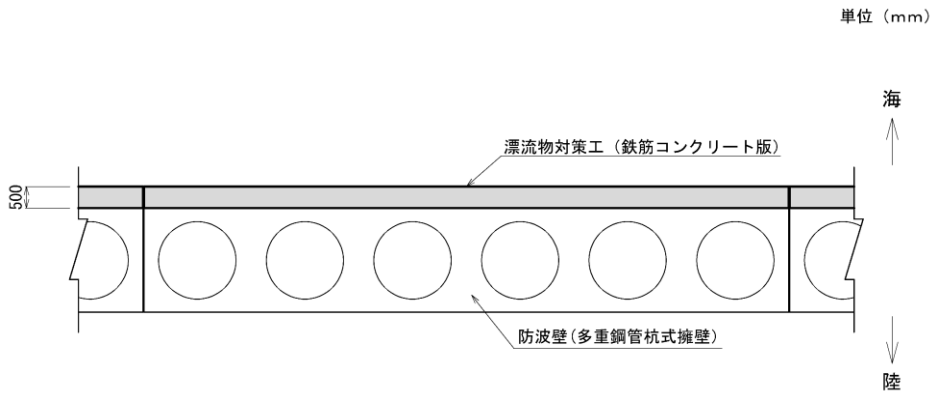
(1) 漂流物対策工(鉄筋コンクリート版)の構造概要図(平面図)
